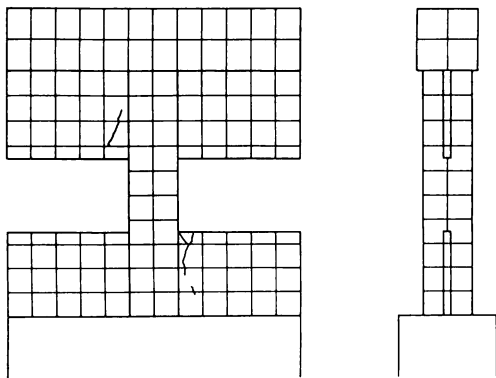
(a) 試験体 CSS01 の初ひび割れ図
